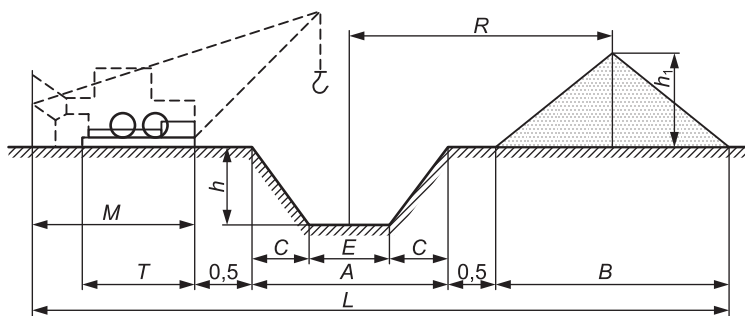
Схема к расчету ширины траншеи и элементов рабочей зоны
